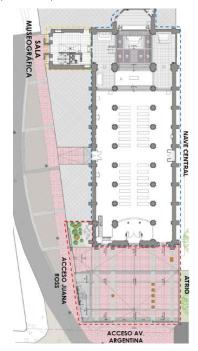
Planta primer piso Parroquia/ Guixe arquitectos Spa.
